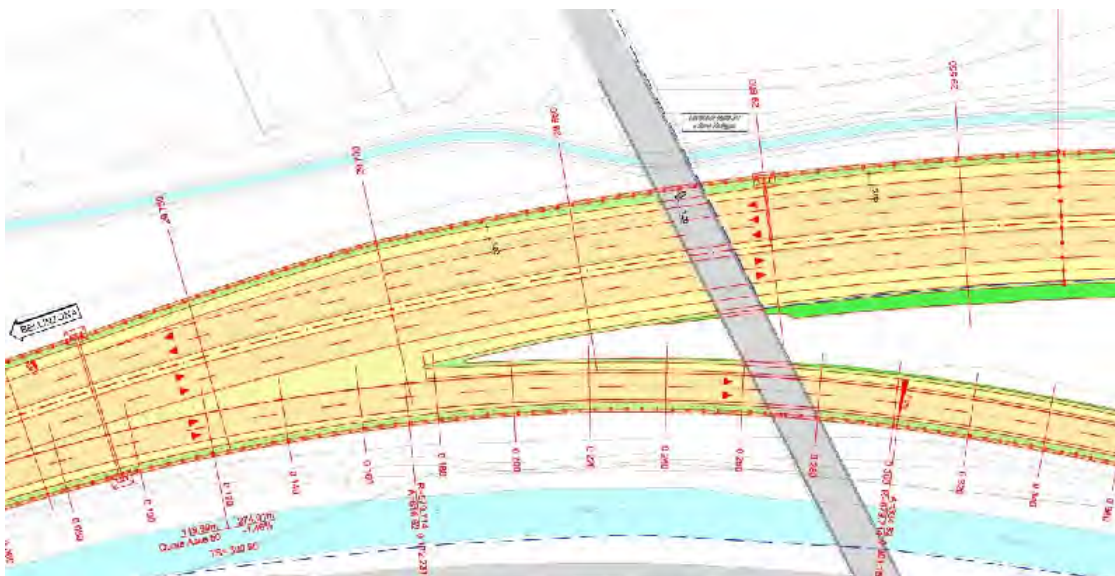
Planimetria: restringimento C.E. presso cavalcavia sopra SN e fiume Vedeggio km 26+622
